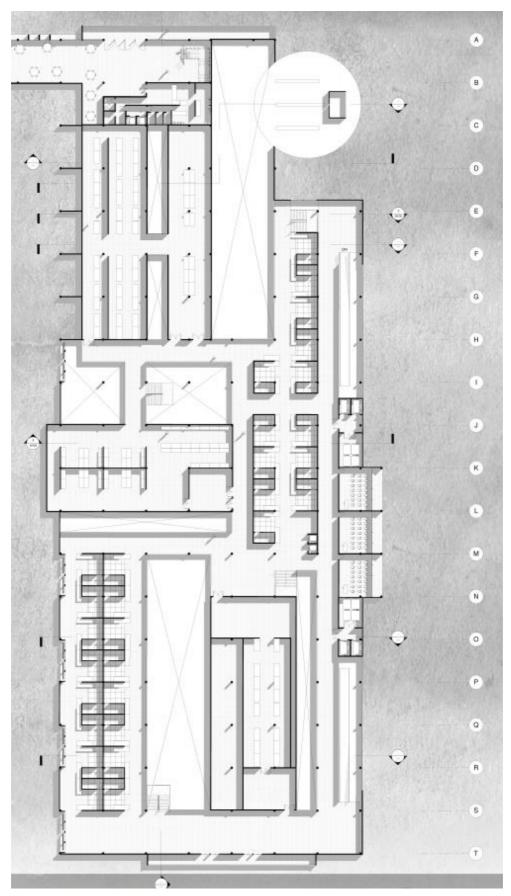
Planta alta 2 mercado Mayorista. Elaboración propia
